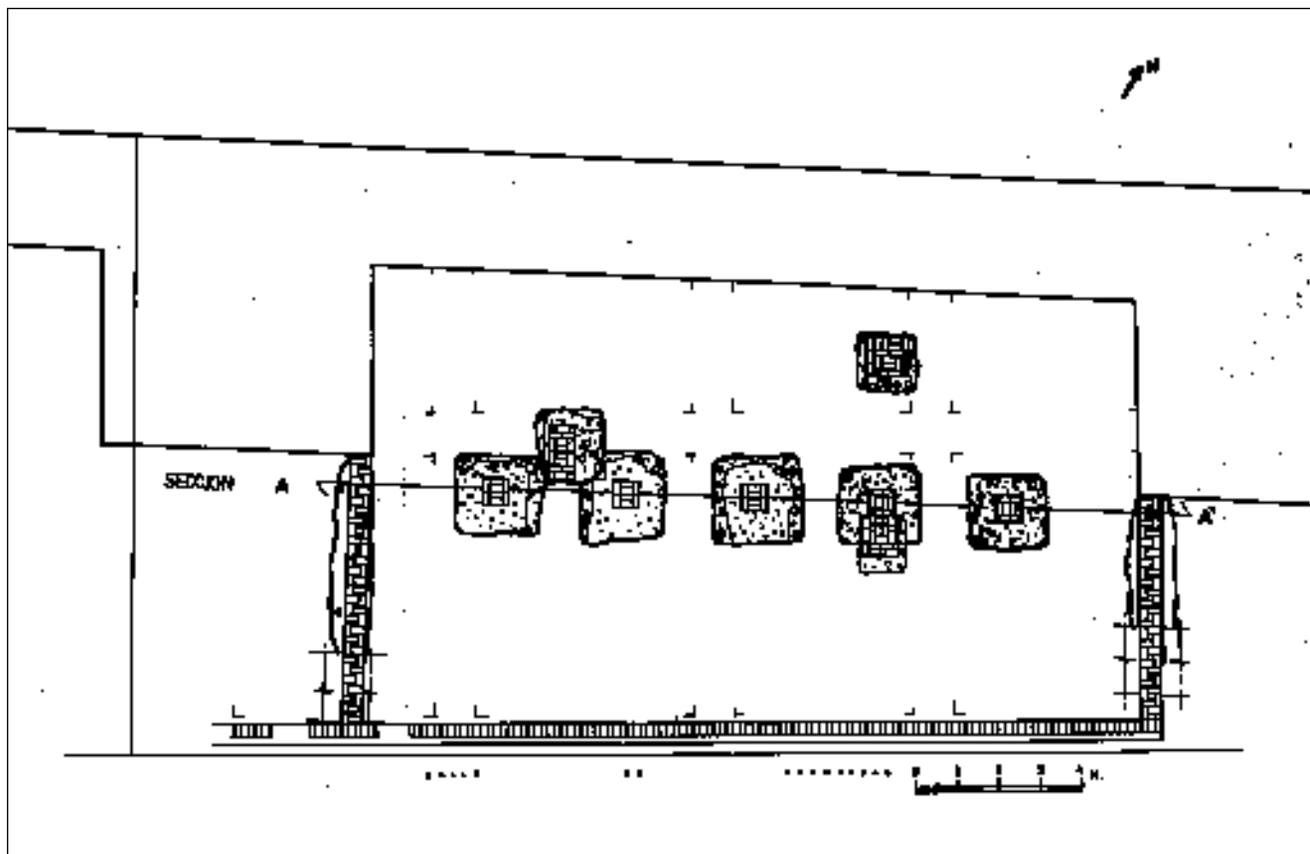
Planta de los pilares y cimientos de la casa n° 2 de la Carretería.
